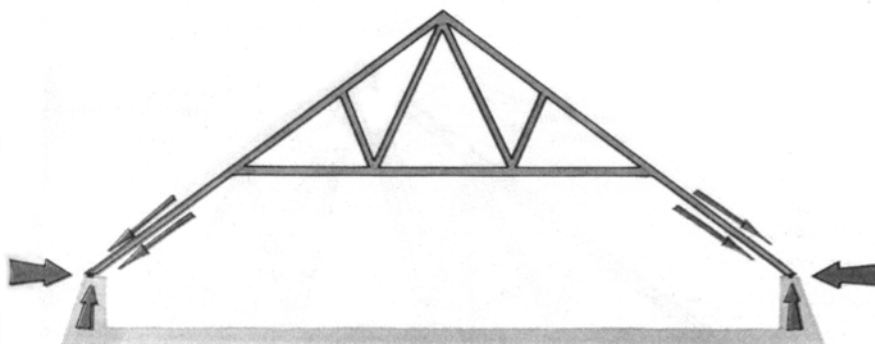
Ferme sans entrait horizontal : grande déformabilité de la charpente si les appuis ne sont pas bloqués ou poussée horizontale sur les murs si les appuis sont bloqués
